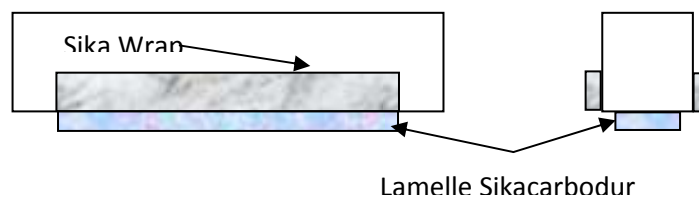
Renforcement poutre par Sika Carbodur et sika wrap [13]
